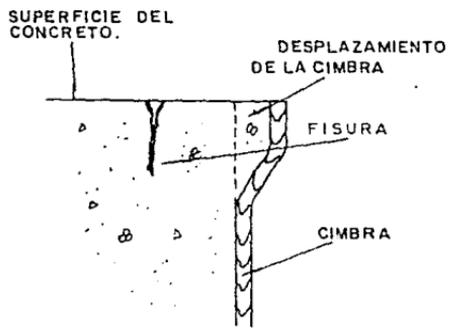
FISURA DEBIDO AL MOVIMIENTO DE LA CIMBRA, DURANTE EL FRAGUADO DEL CONCRETO.
